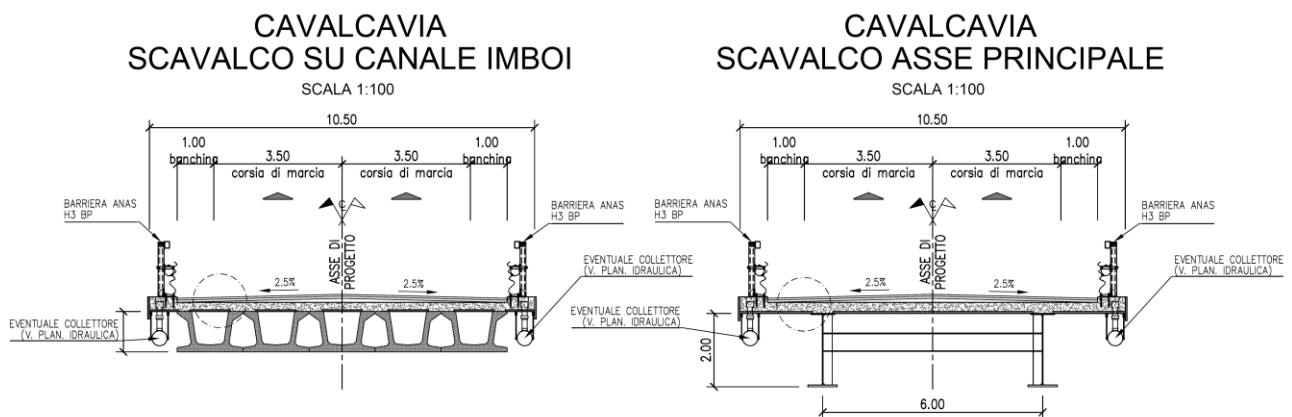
Sezione tipo Asse Cavalcavia su Scavalco canale IMBOI e Asse Principale
